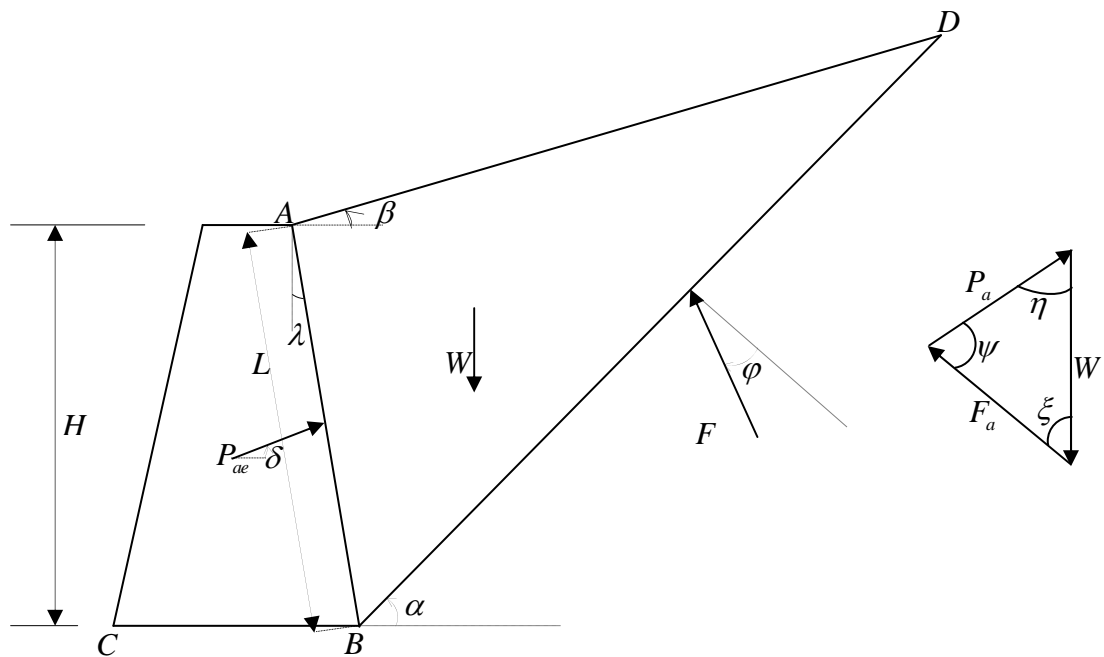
Prisme de poussée, murs de soutènement déplaçable.
